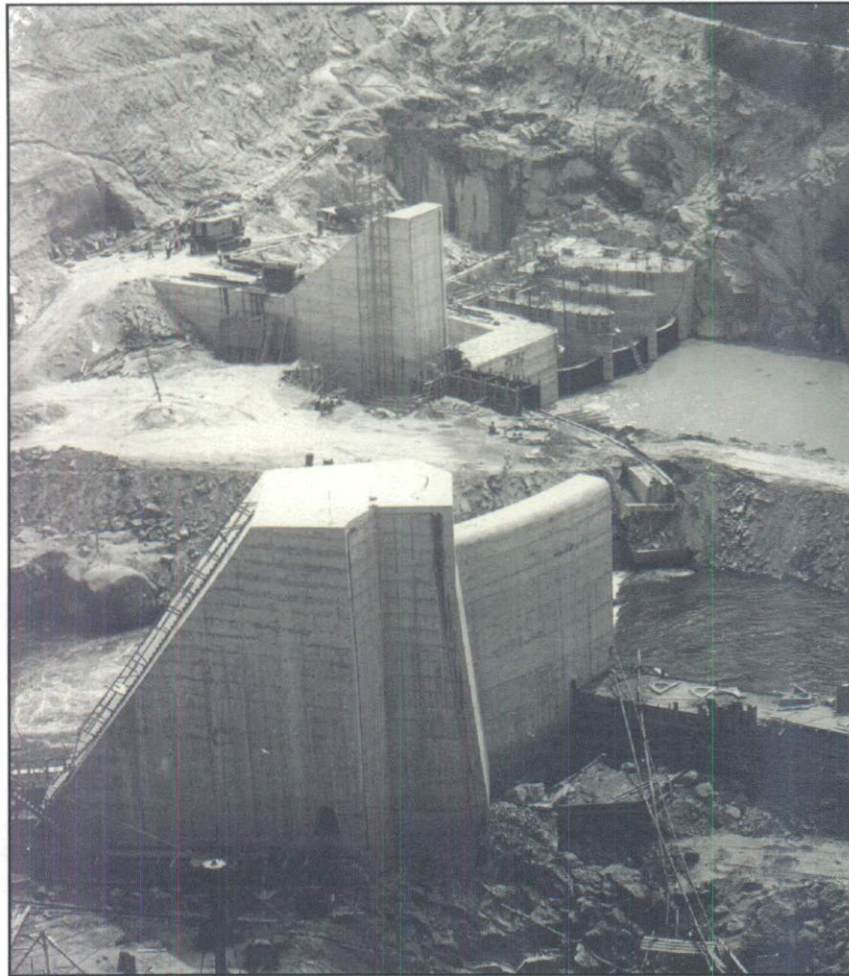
Vista da construção da Barragem Principal (FONTE: FURNAS).
